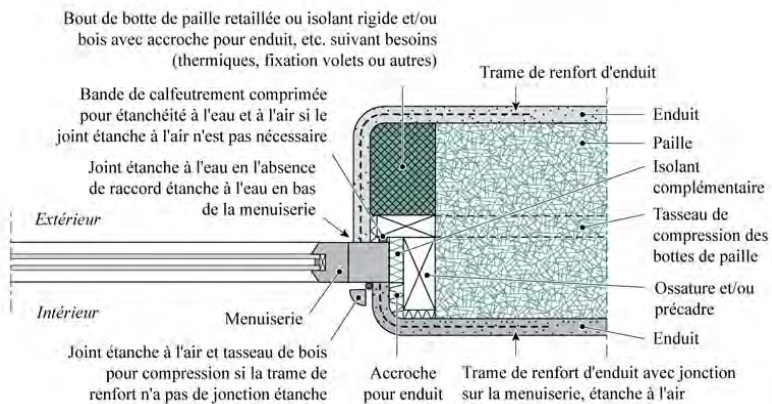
étanchéité autour d'une fenêtre. Photo : Guillaume Charrier
